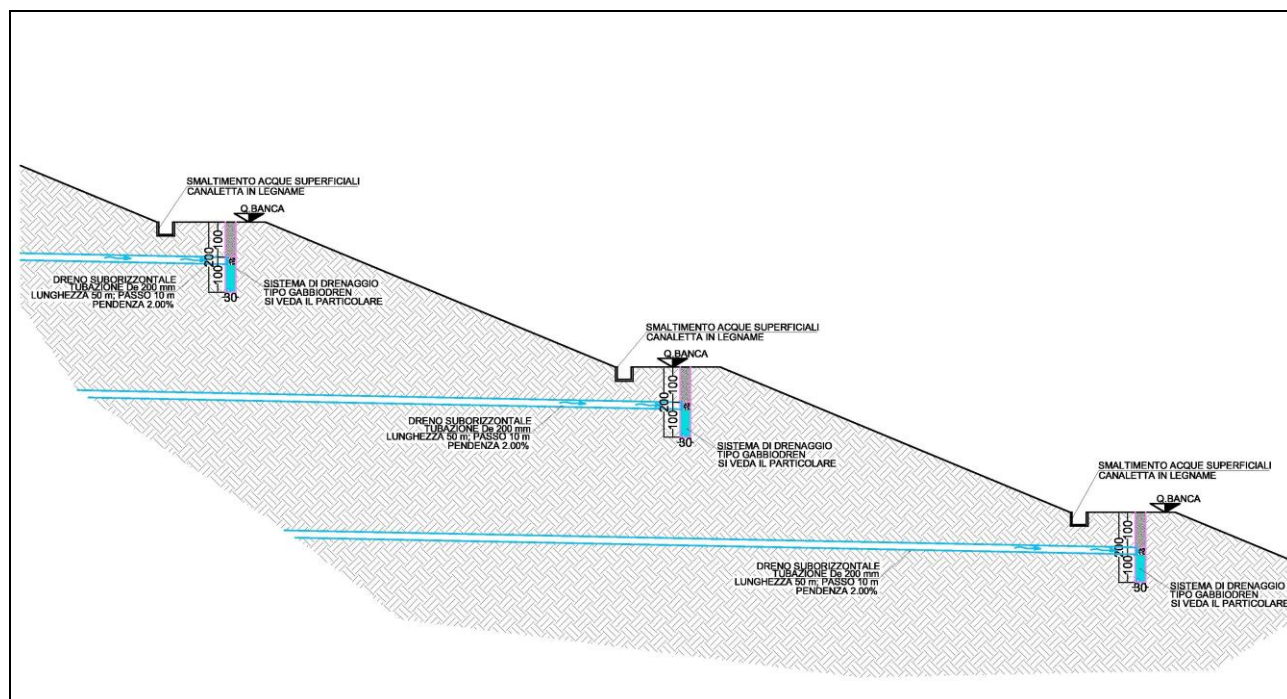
Particolare posa trincee drenanti tipo Gabbiodren
